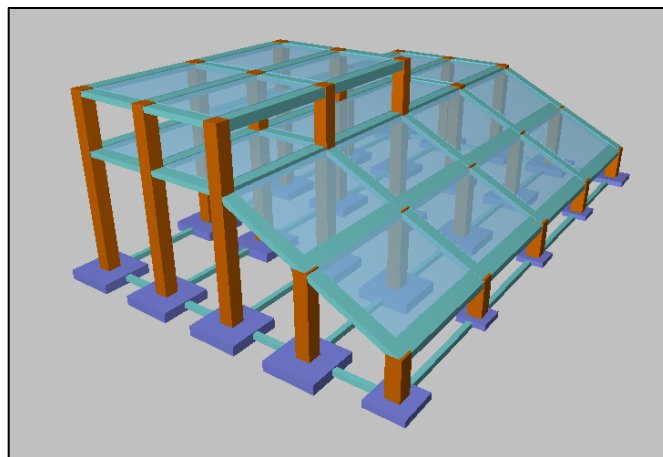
Diseño 3D de la estructura en CYPECAD.
